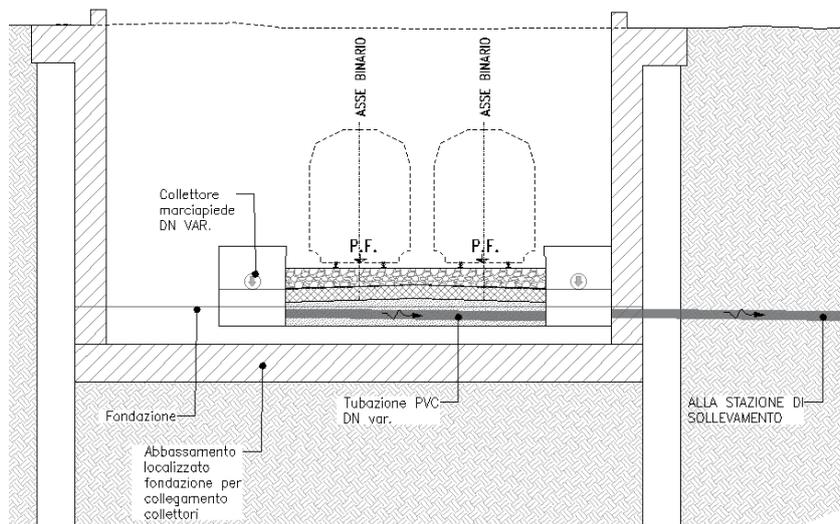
Sezione tipo Abbassamento localizzato fondazione
